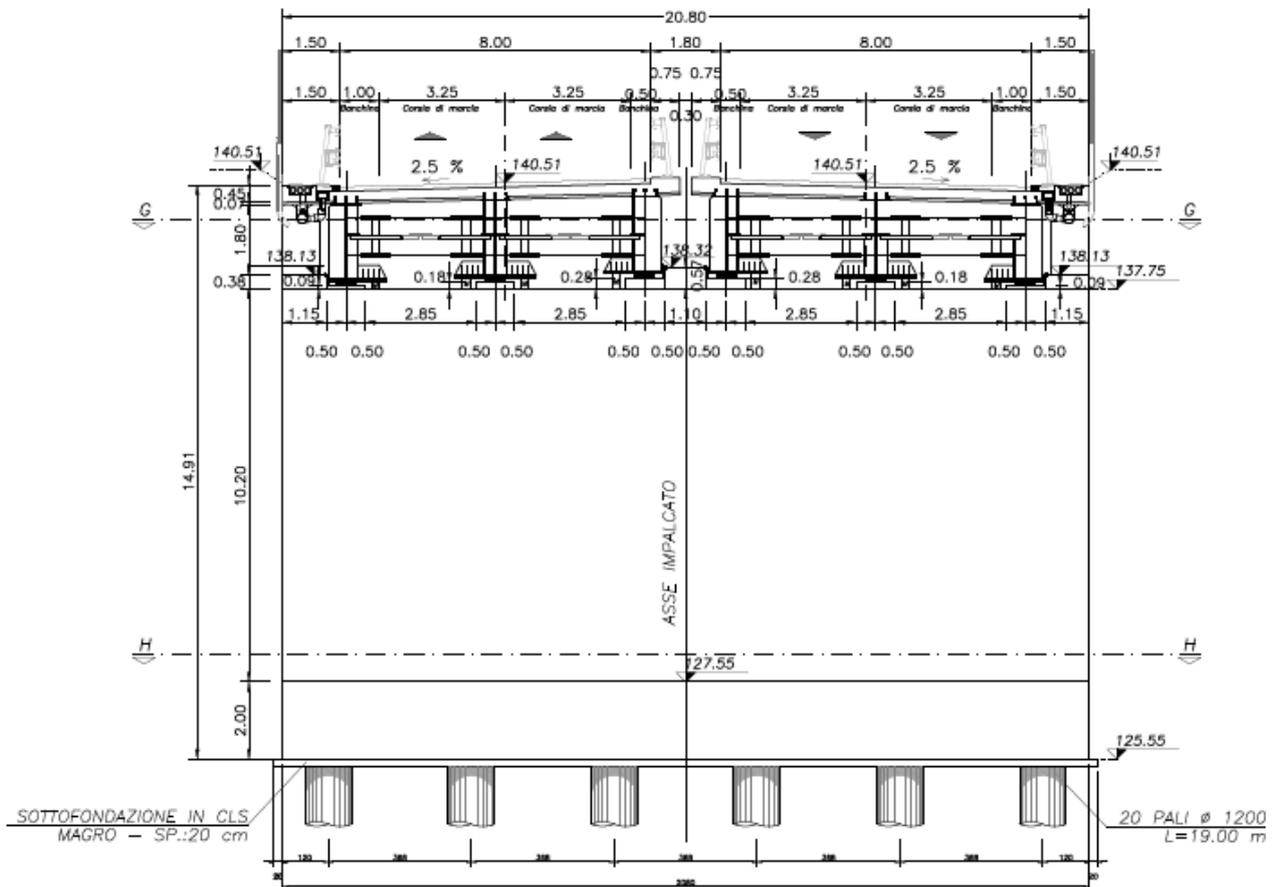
Sezione trasversale del cavalcaferrovia IV15 nel progetto in variante
